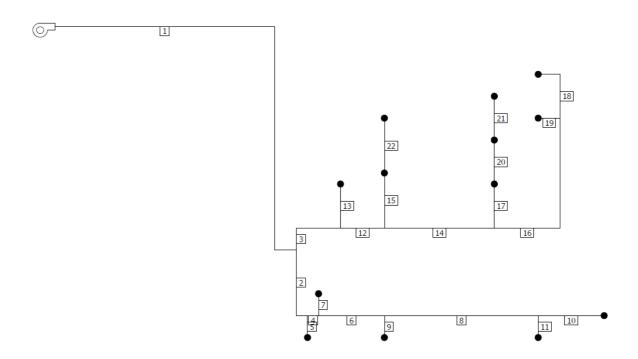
Distribución ramales Planta Baja Cl Comunes
